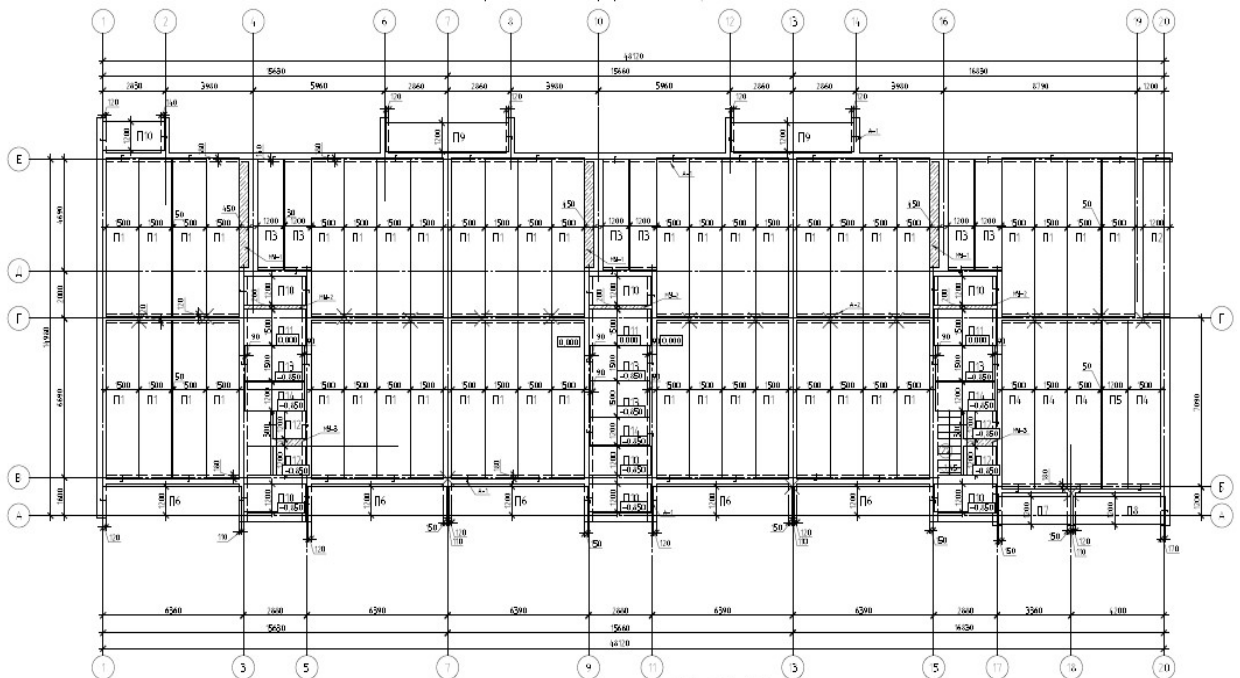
схема расположения плит перекрытия на отм. -0,300
